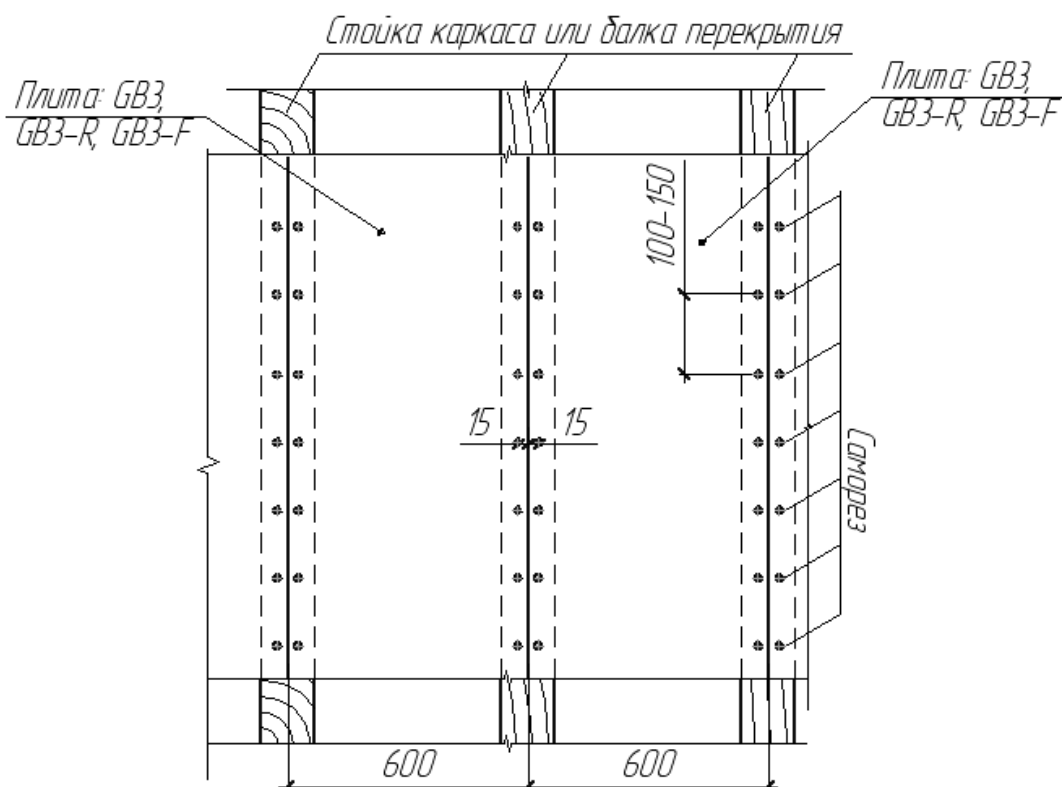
Крепление плит GB3 к каркасу параллельно относительно или стоек каркаса или балок перекрытия
